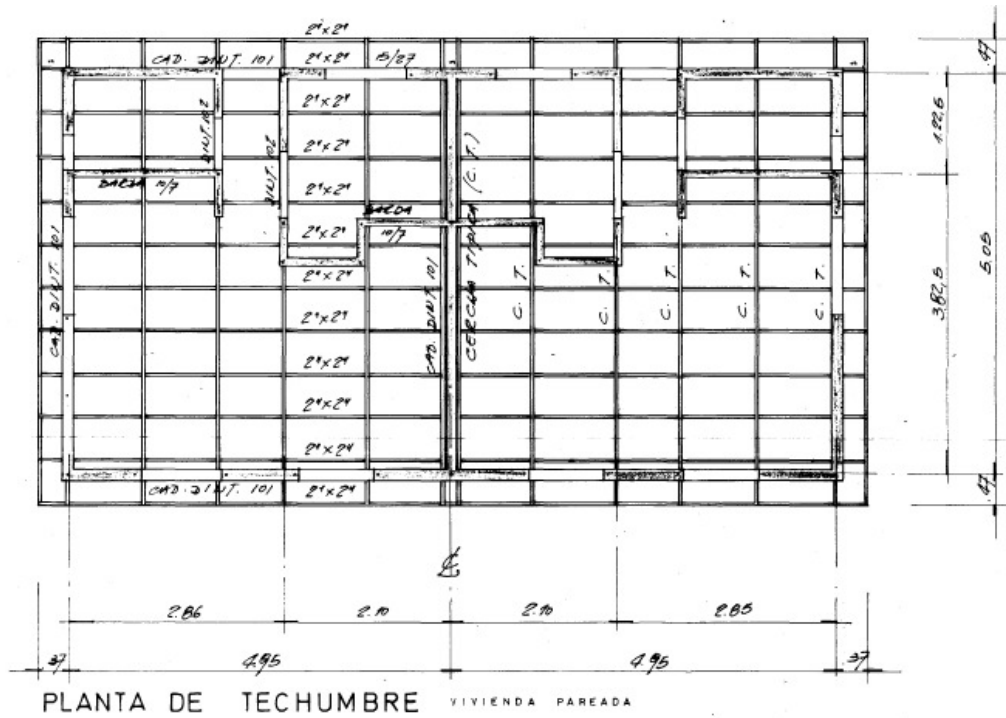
Dimensiones de la planta de las vivienda pareadas (Caso 250a).
